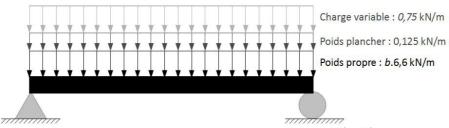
Charges sur la poutre en bambou lamellé-collé
